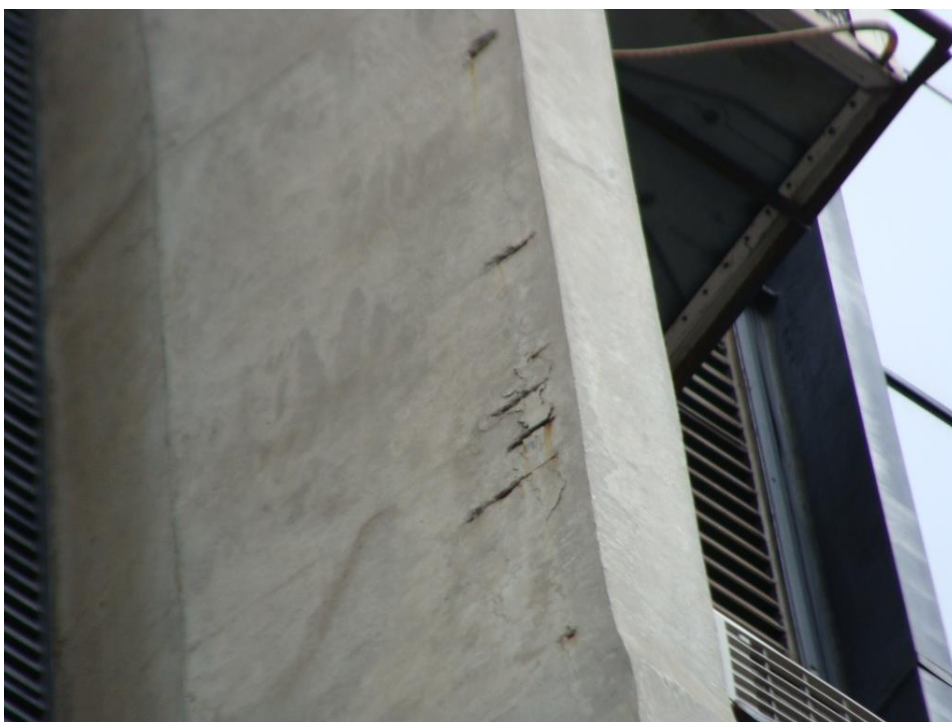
Armadura exposta pilar P12 (3º pavimento) (02/03/2021)
